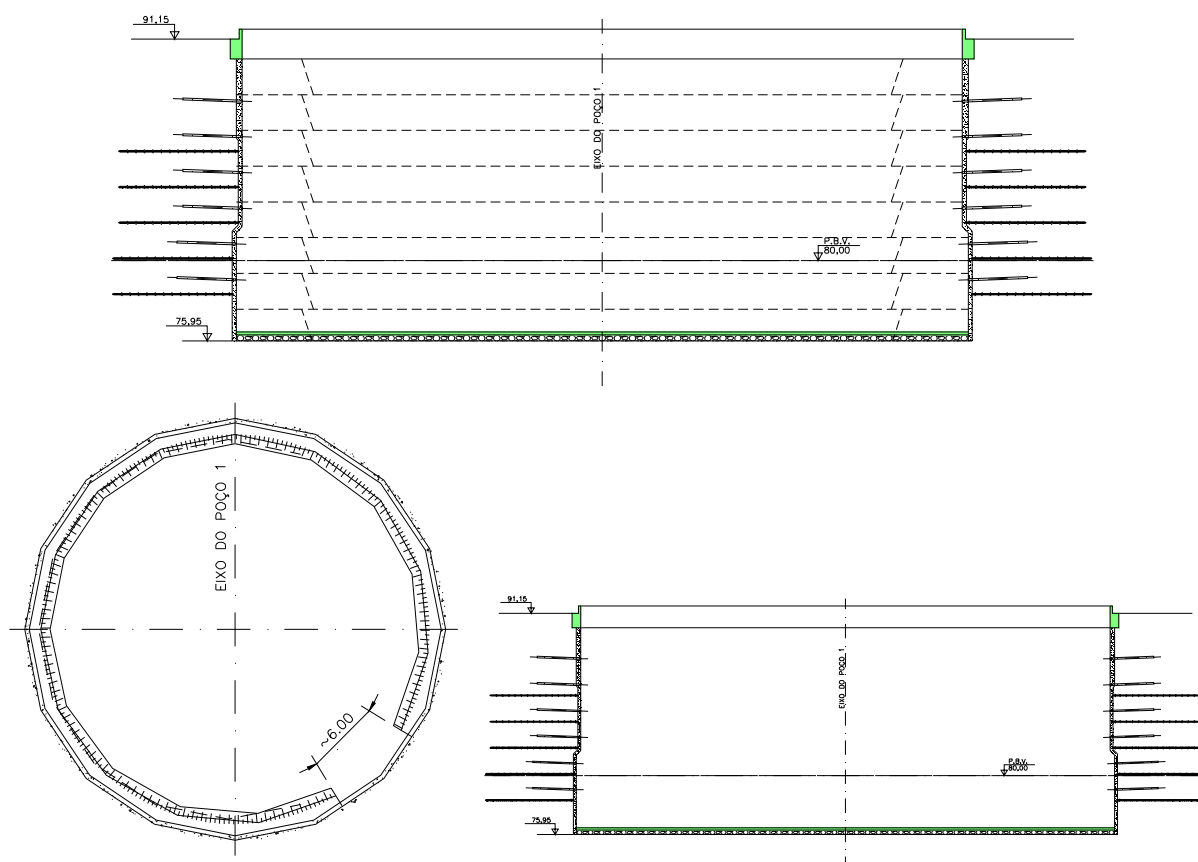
Esquema da escavação (com pregagens) e do suporte de 1ª fase – Poço 1 da Estação
